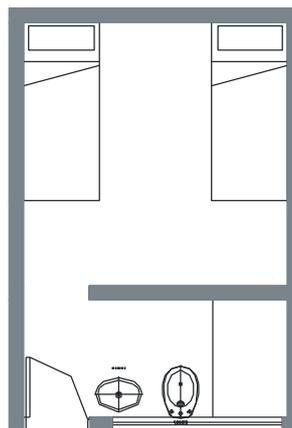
Planta baixa cela, modificado em 10 anos de uso.
